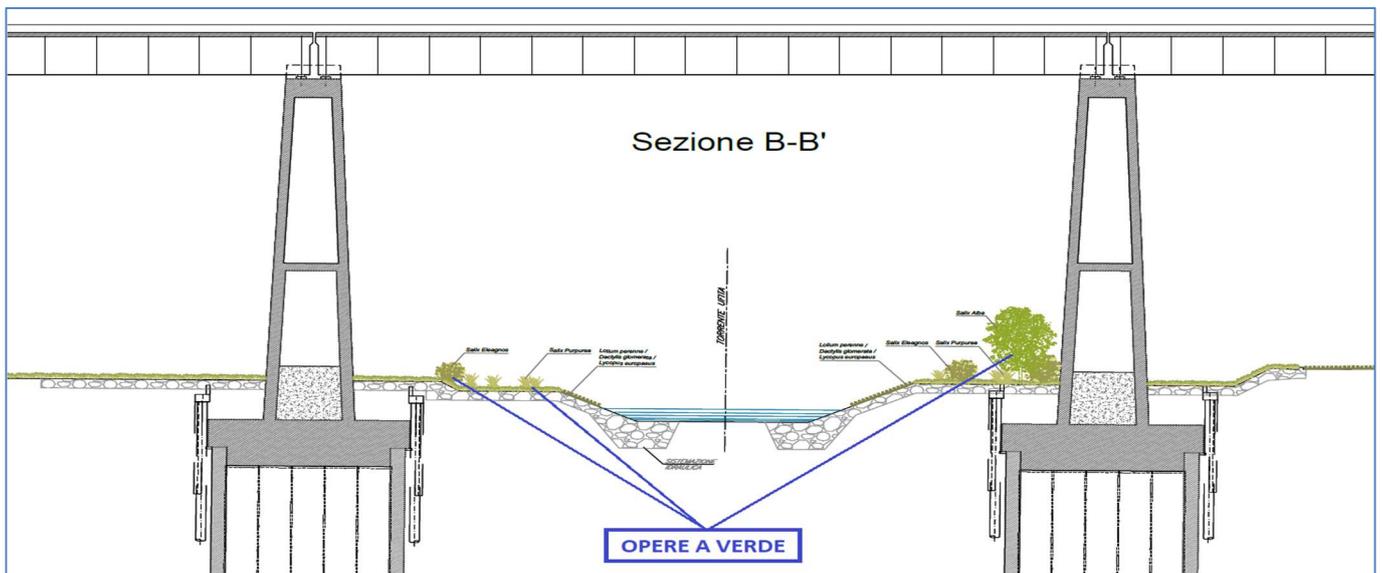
Profilo Longitudinale con indicazione delle Opere a Verde
